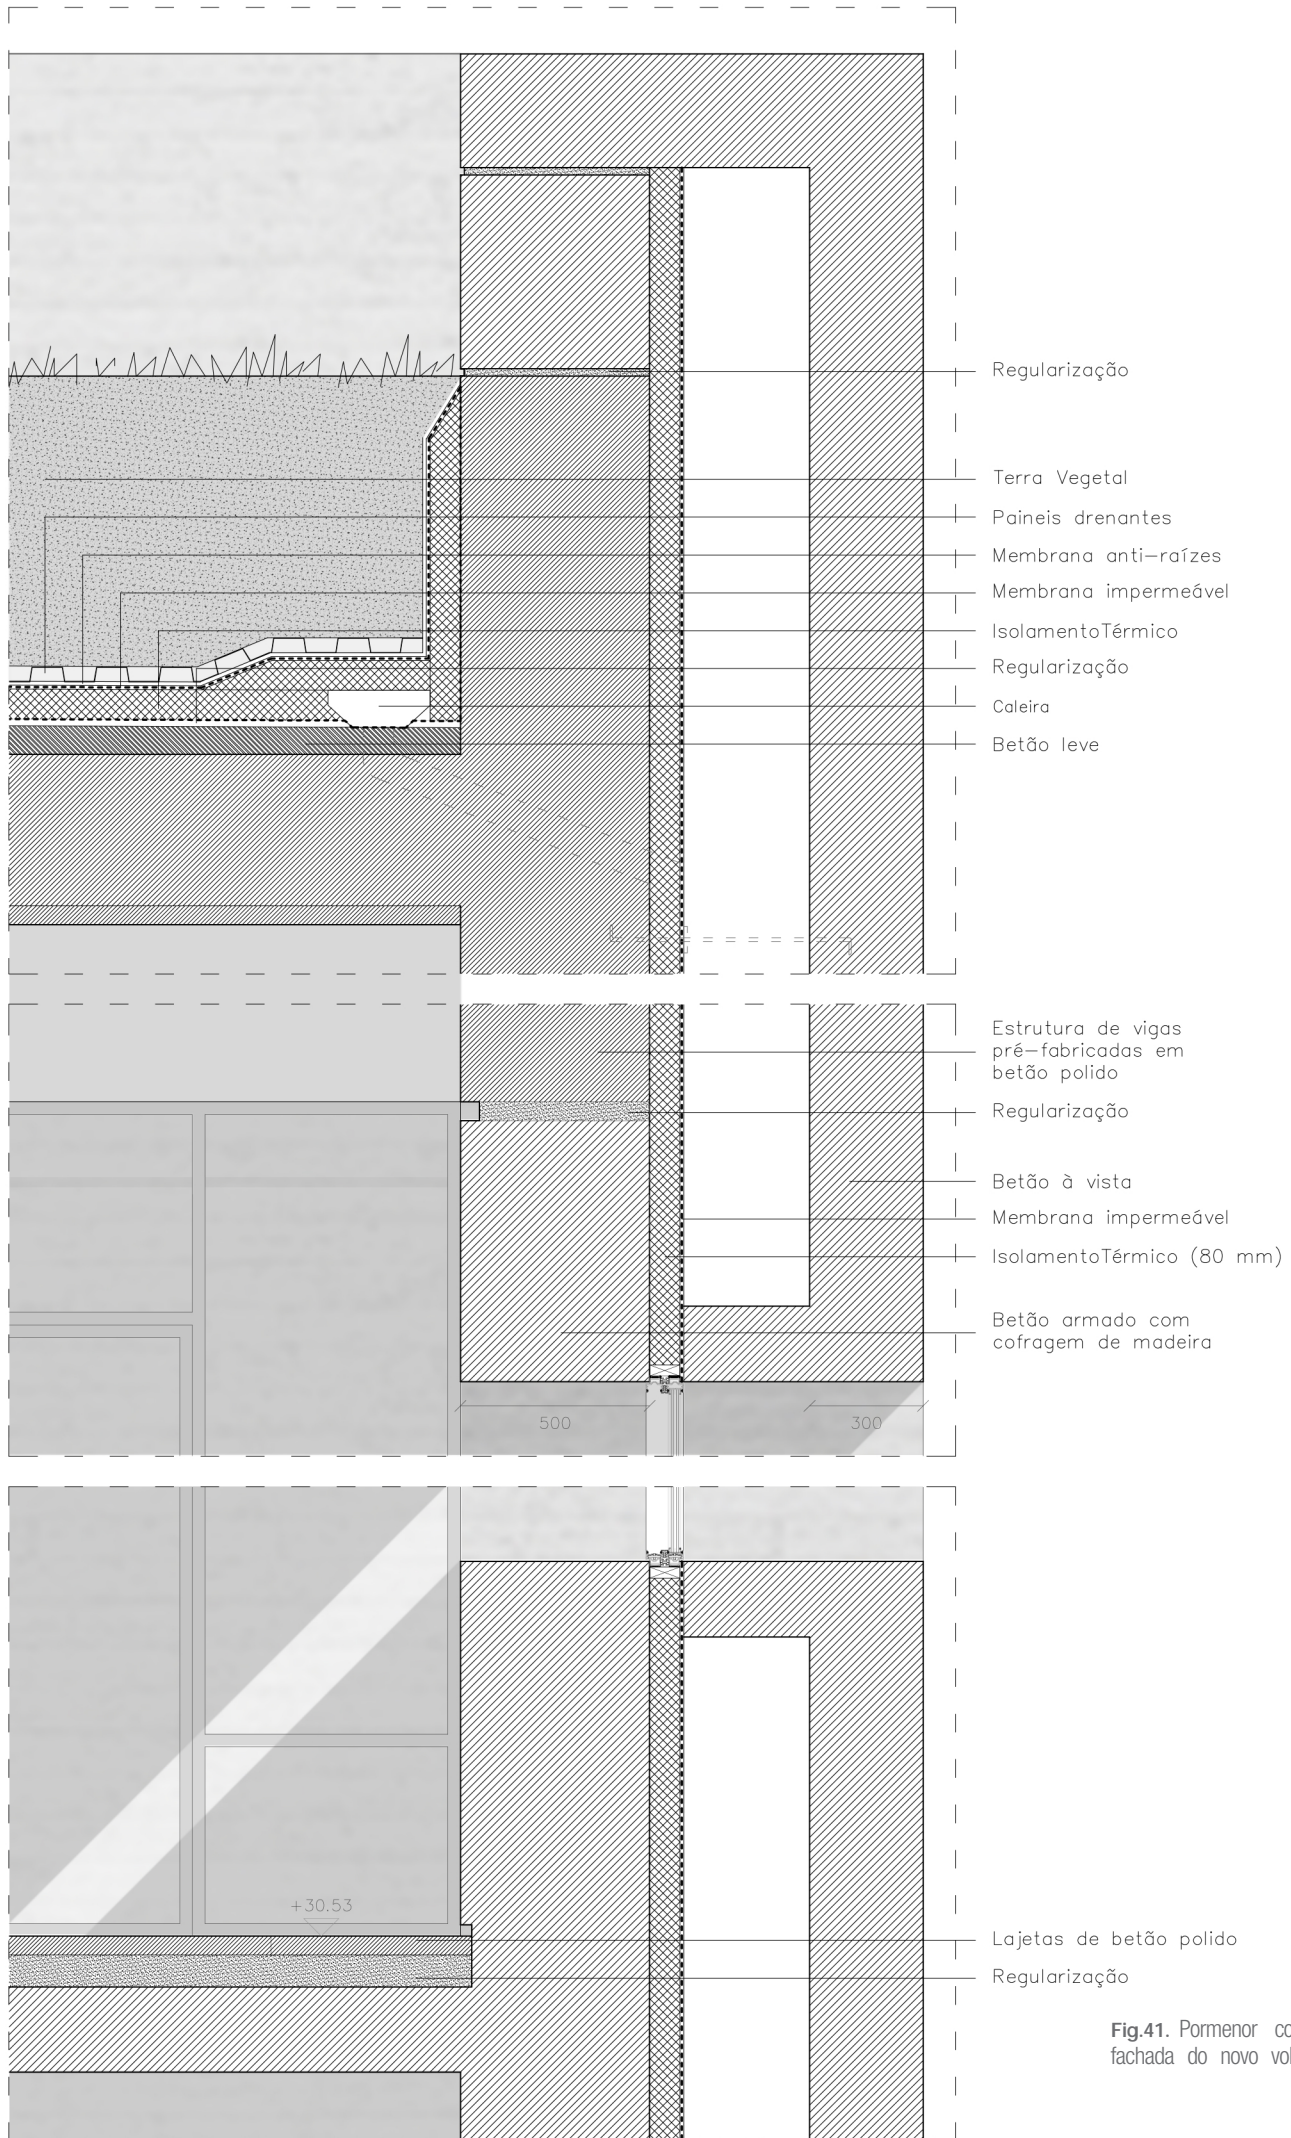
Pormenor construtivo da fachada do novo volume | 1:10
